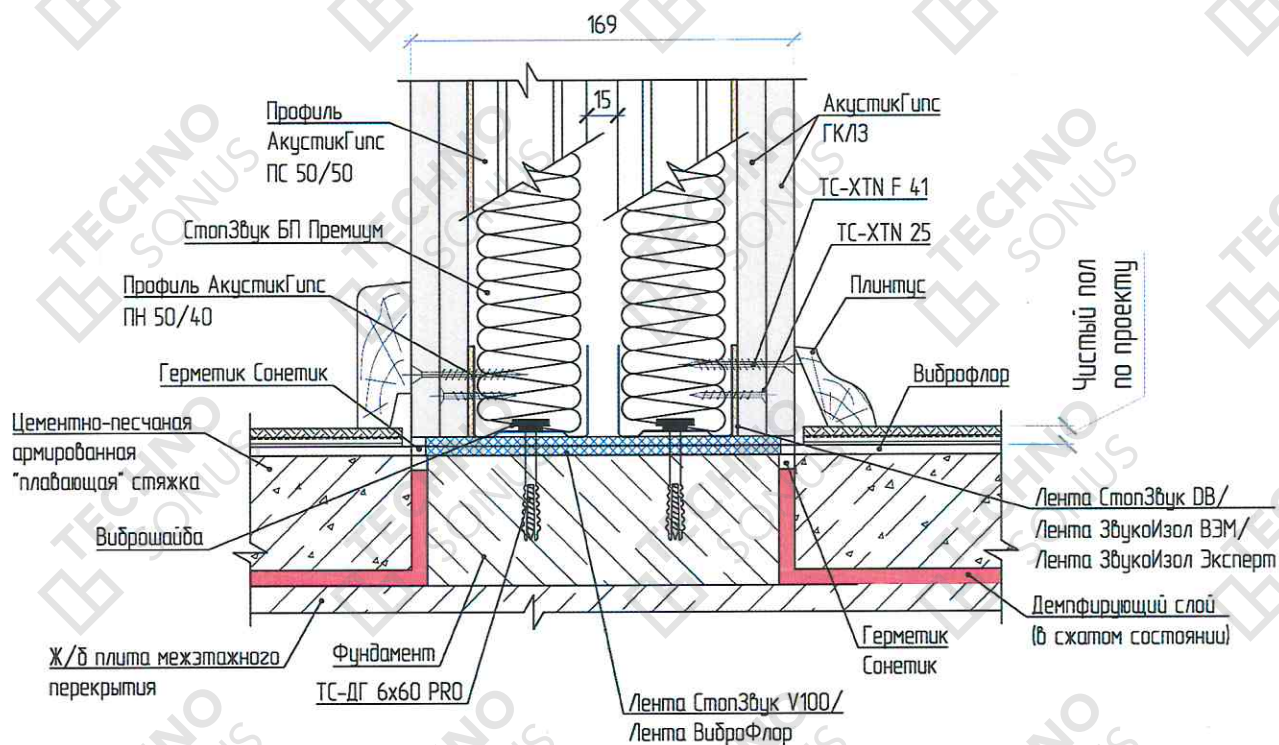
Примыкание перегородки к плите перекрытия (Вариант 1)
